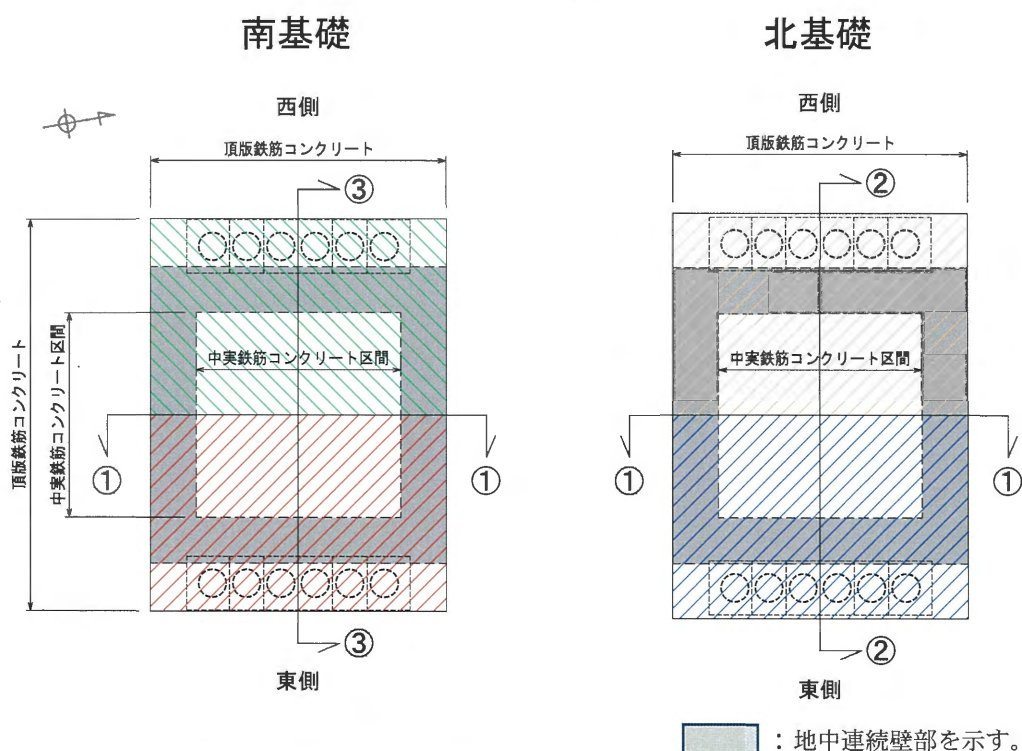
評価位置図（頂版鉄筋コンクリート）
